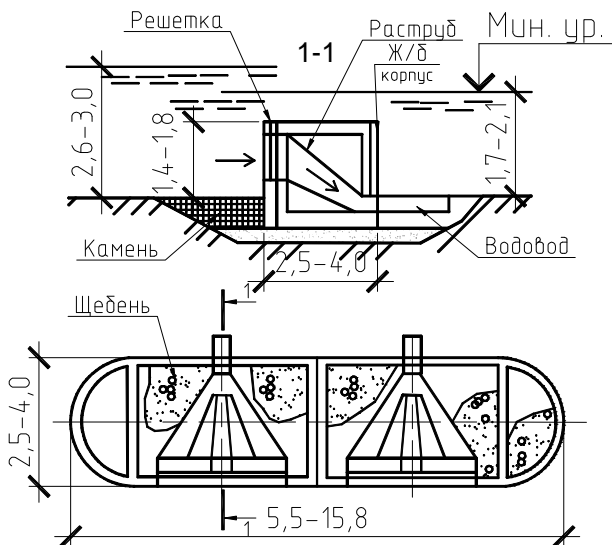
Железобетонный раструбный оголовок с боковым подводом воды
